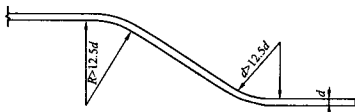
弯起钢筋弯折处圆弧内半径示意图
